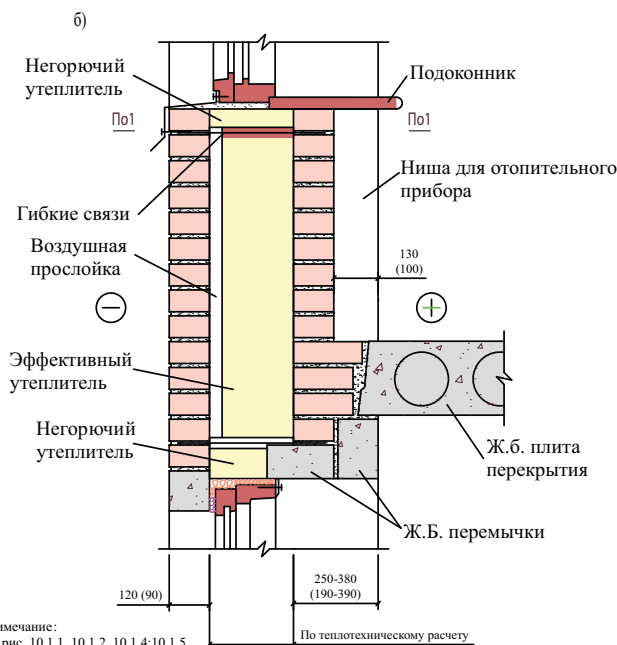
г. Междуюконный пояс наружной стены для зданий высотой один-три этажа с самонесущим наружным слоем из кирпича, бетонных или керамических камней на гибких связях (тип ГС-1) с самонесущим внутренним слоем
